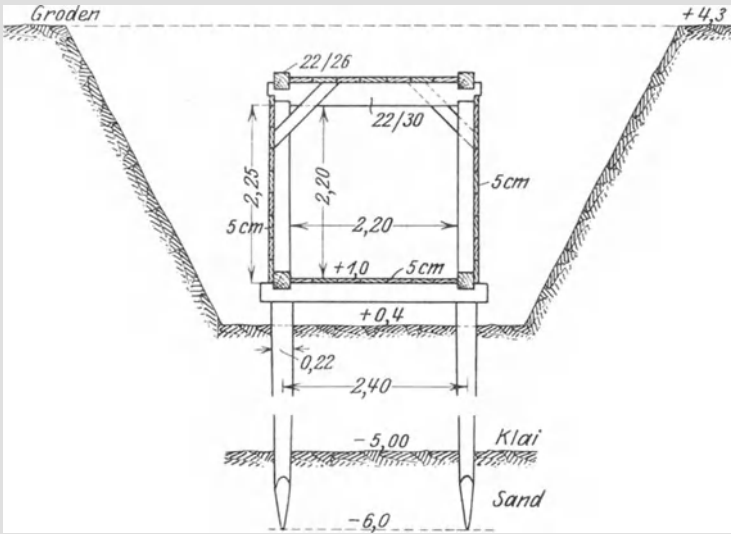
b. Querschnitt mit Baugrube. Maßstab 1 : 100.
